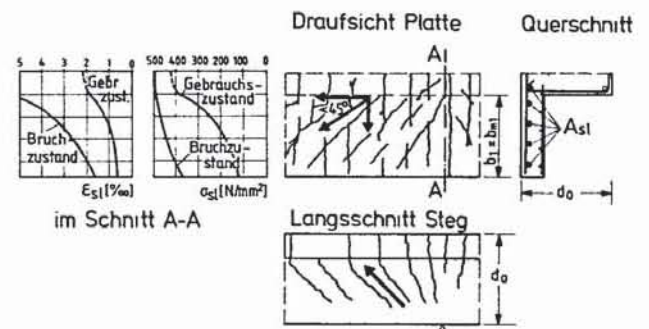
Beanspruchung eines Plattenbalkens im Stützbereich (nach [33])
